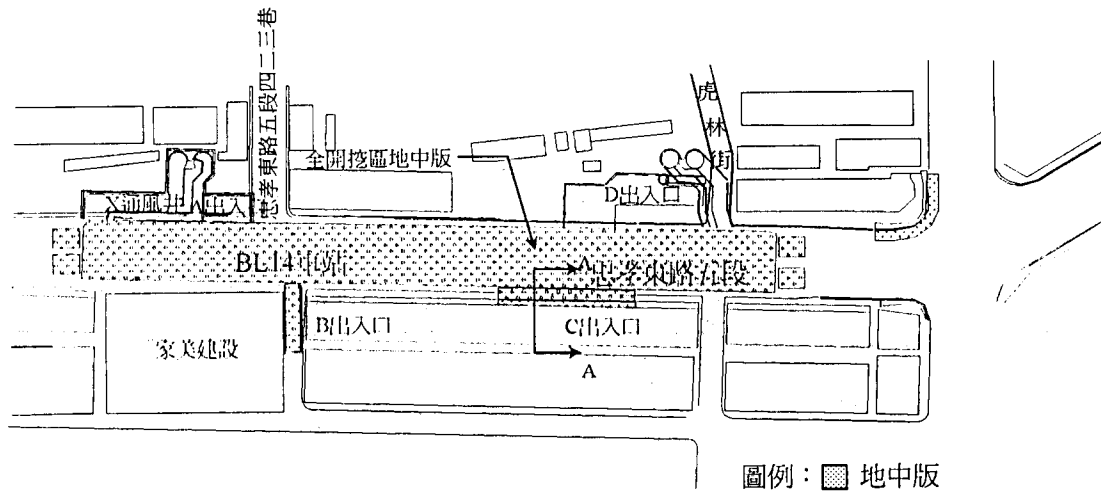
CN258標支撐穩定設施平面及剖面示意圖(地中版)
